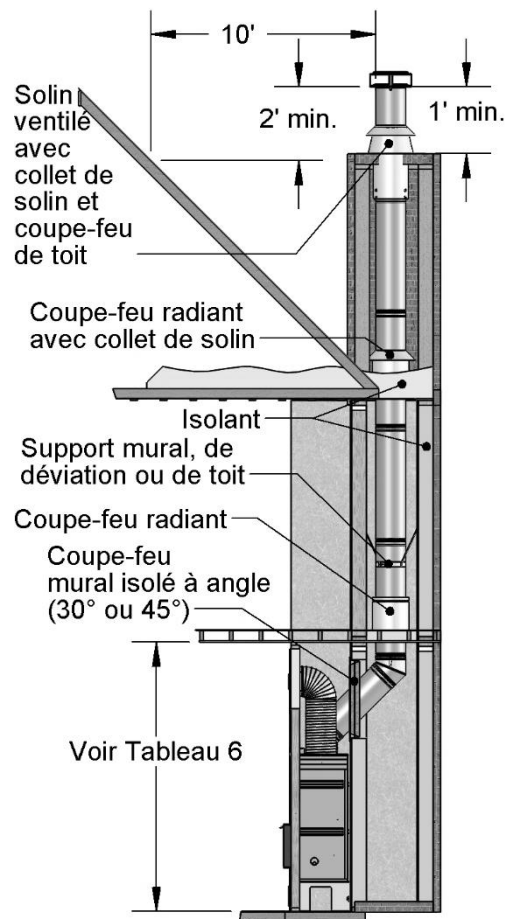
EXEMPLE D'INSTALLATION À TRAVERS LE MUR
